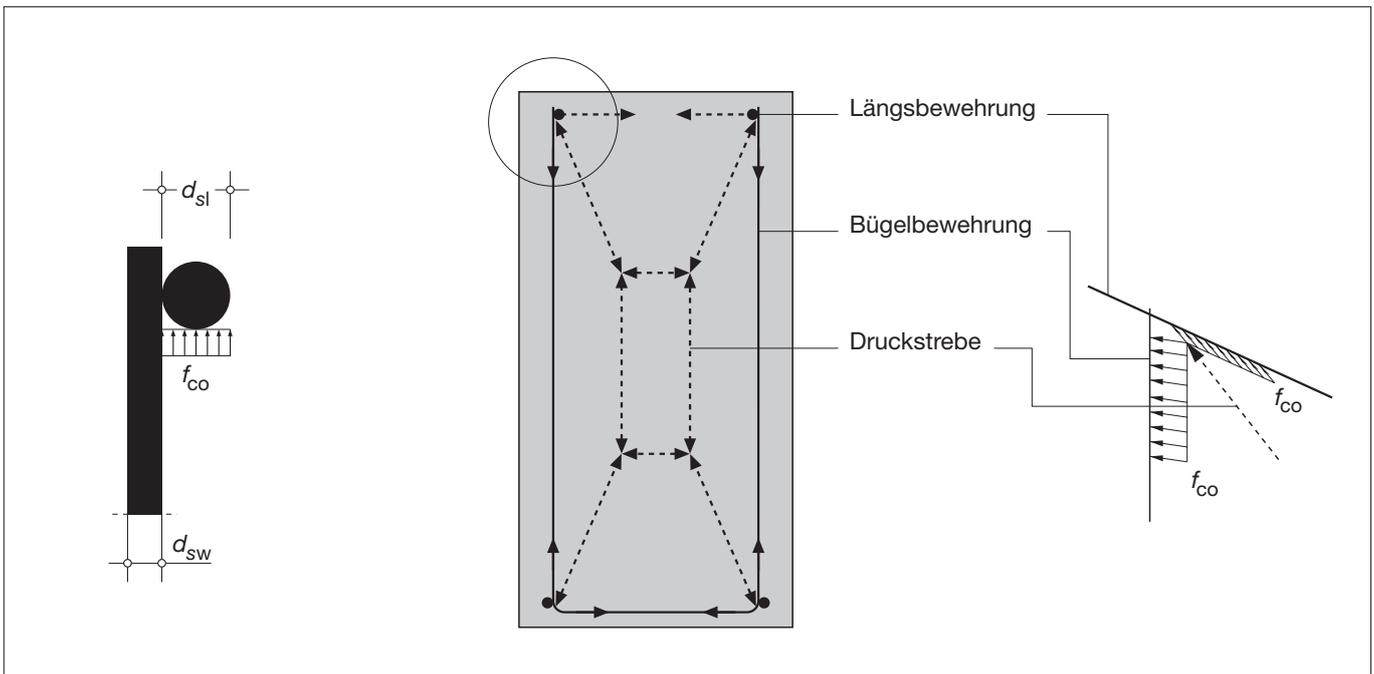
Einleitung der Druckstrebenkraft bei offenen Bügeln
